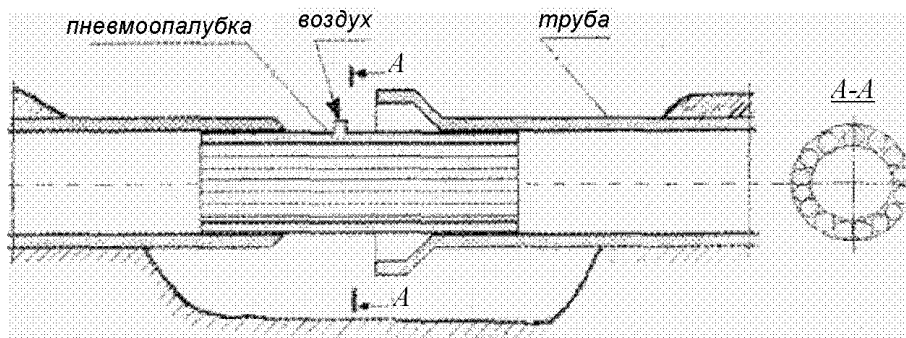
Схема надувной трубчатой опалубки Маклина и Скотта
